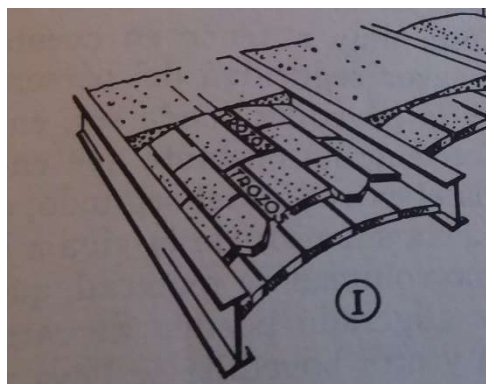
Detalle de la construcción con bovedilla tradicional.
